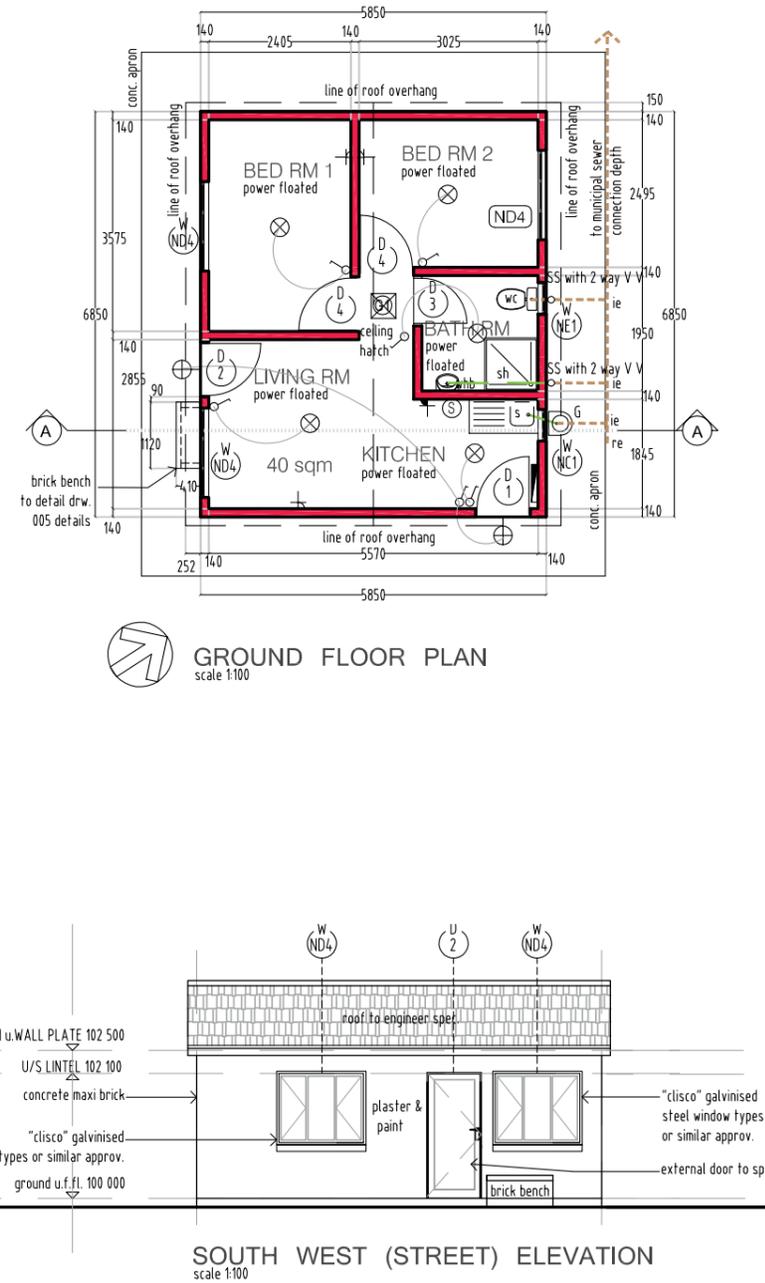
Planta y alzado de la vivienda tipo ya distribuida por los arquitectos gubernamentales
